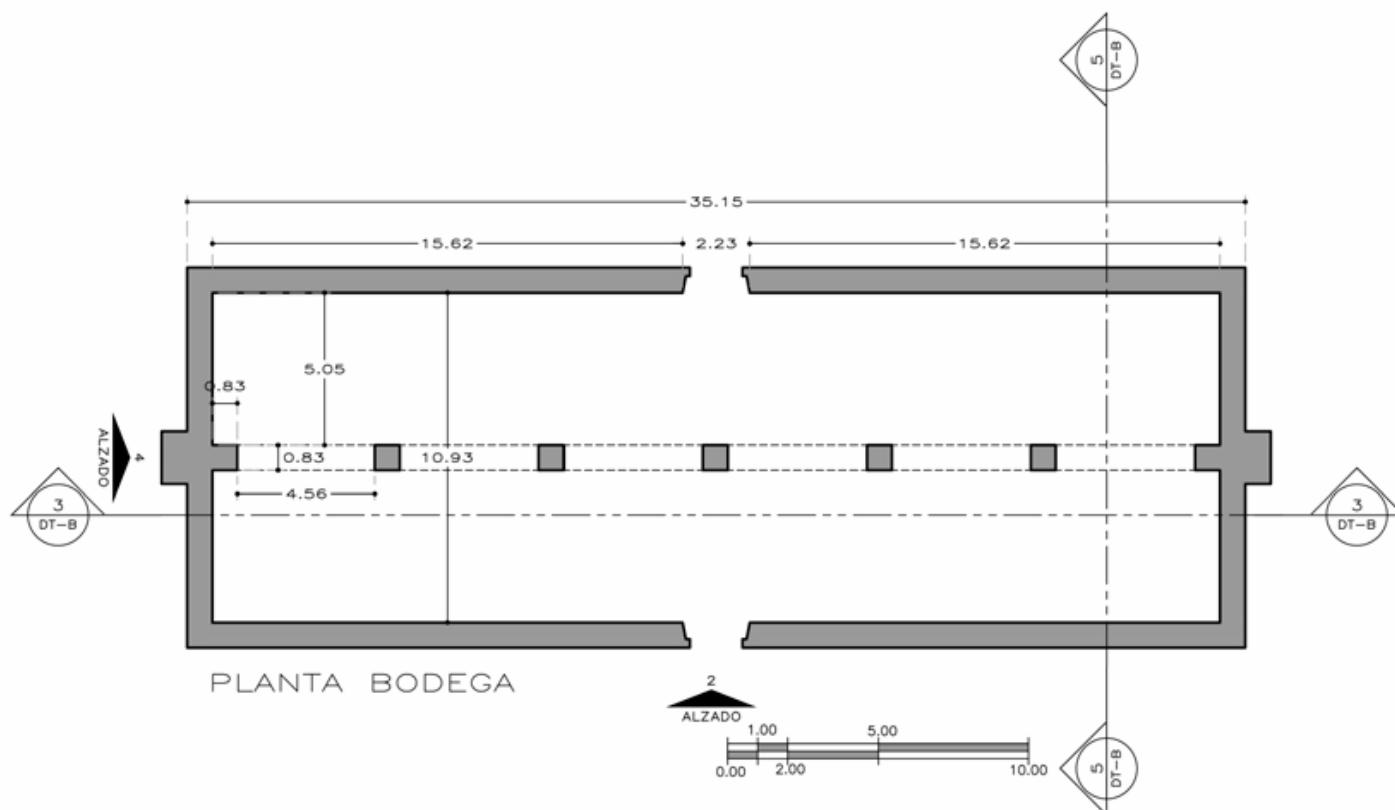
Planta fábrica Santa Rosa, por X. Guevara, México, 2014
